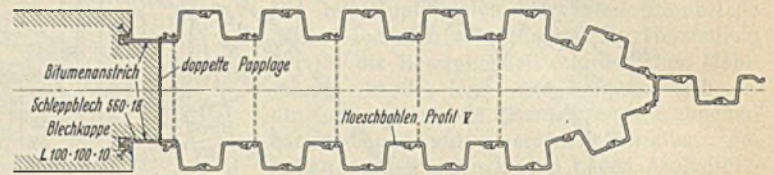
Waagerechter Schnitt durch den beweglichen Anschluß des Wehres an den Düker.
